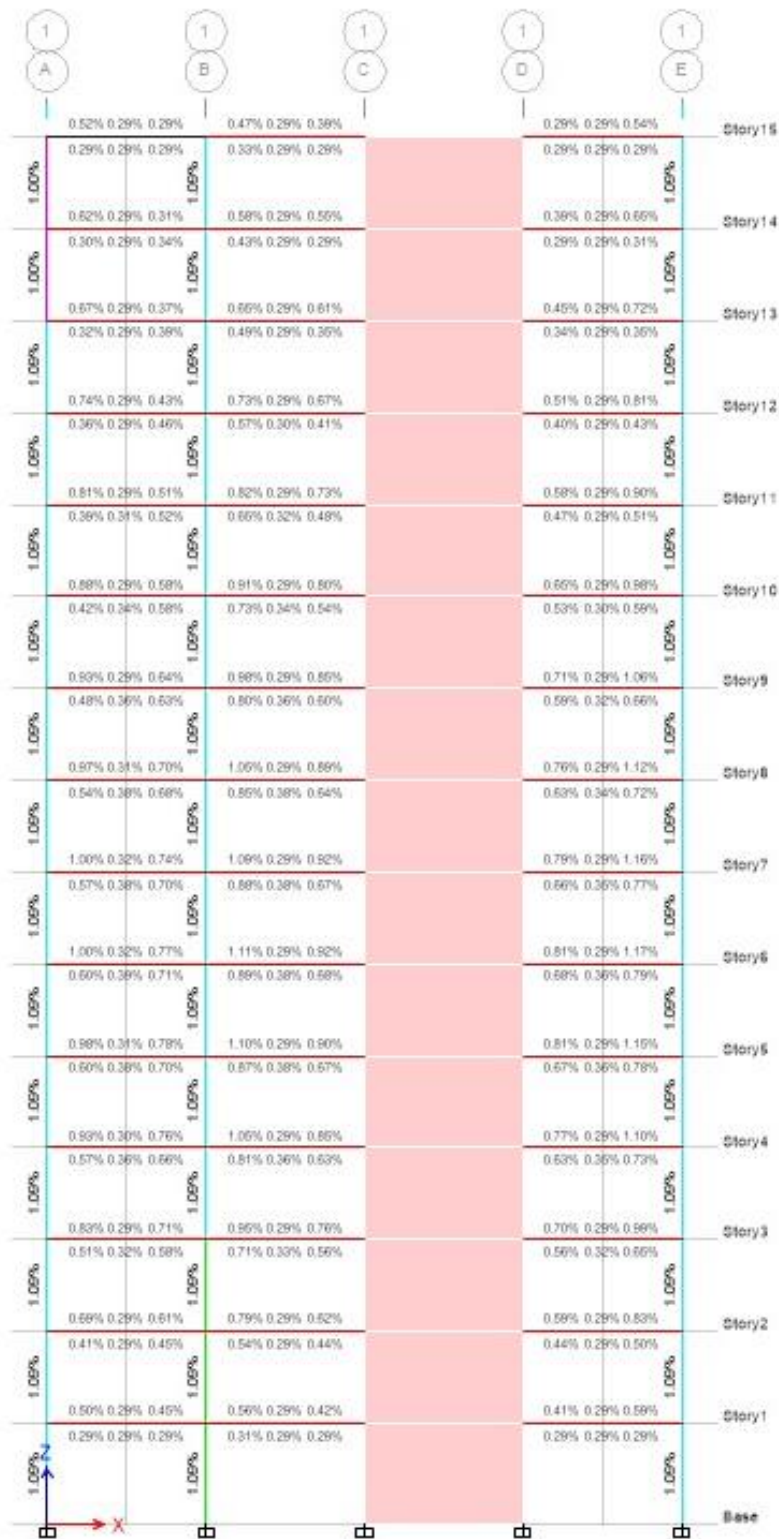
Diseño de columnas con 12 varillas de 1" en la elevación 1
